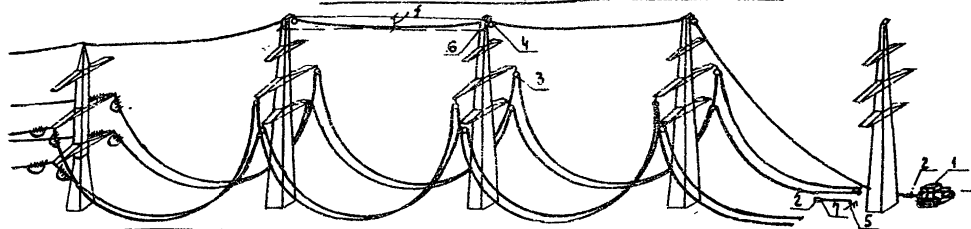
Нормы и допуски на монтаж проводов
